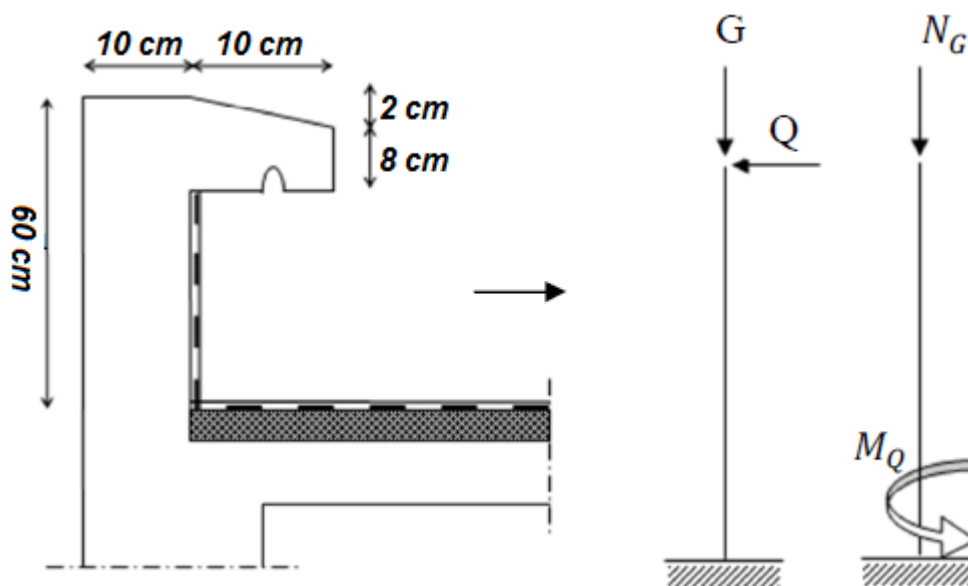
Schéma statique et dimensions de l'acrotère.
